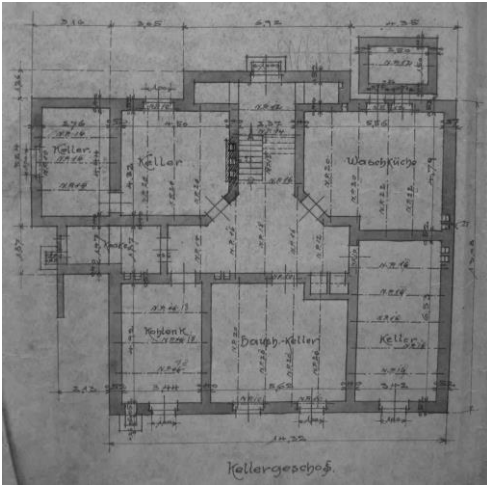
Grundriss Kellergeschoss
